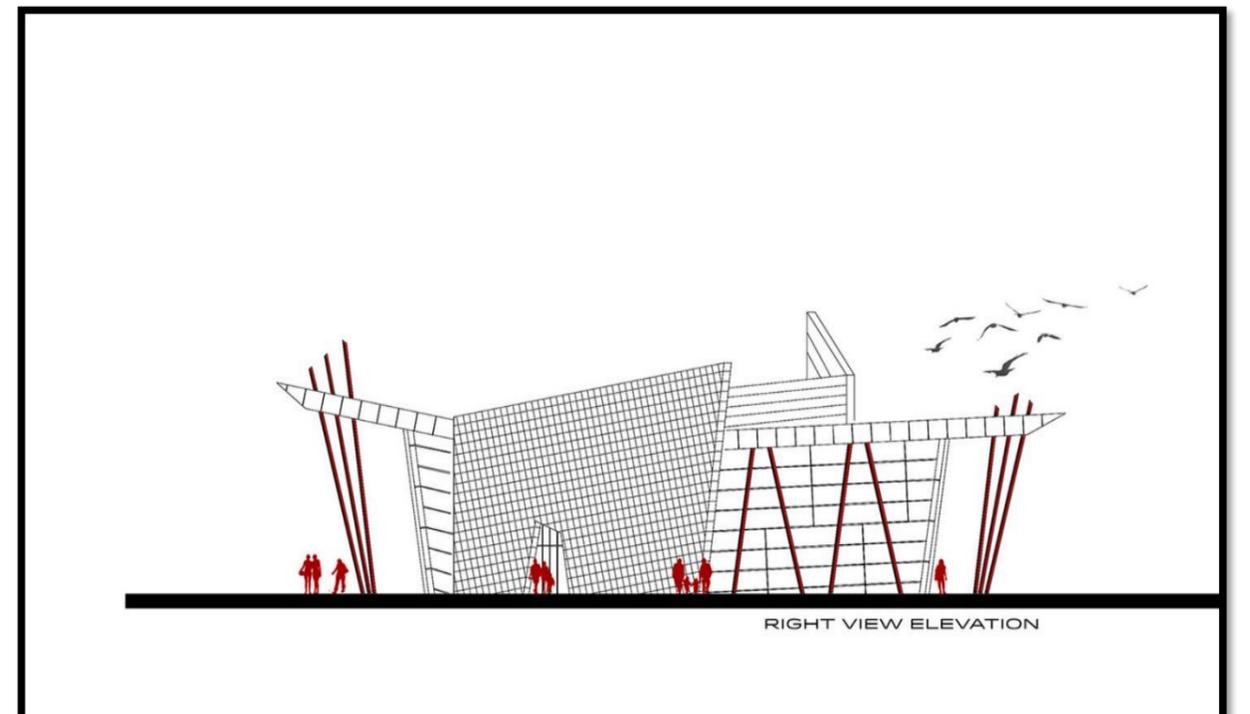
Elevación derecha de la terminal de Kayseri. Fuente: Plataforma Arquitectura.
